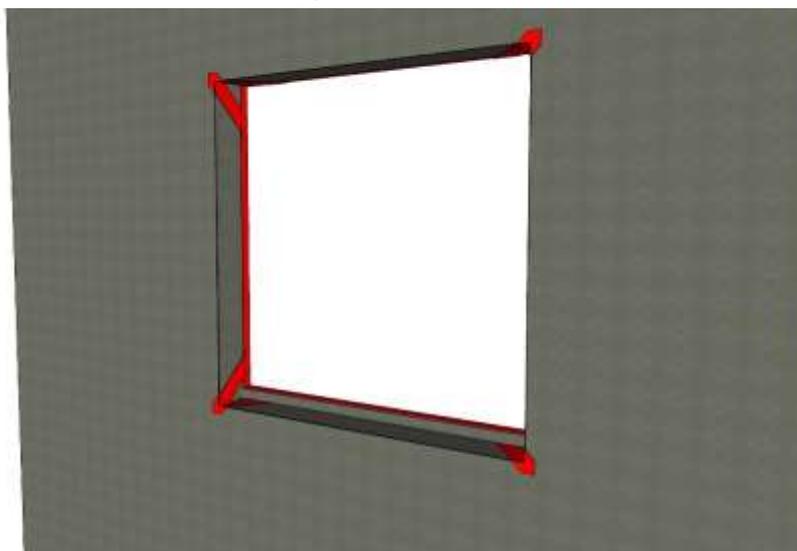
Pose d'une bande adhésive d'étanchéité à l'eau au niveau des rabats du pare-pluie et de la traverse d'appui
